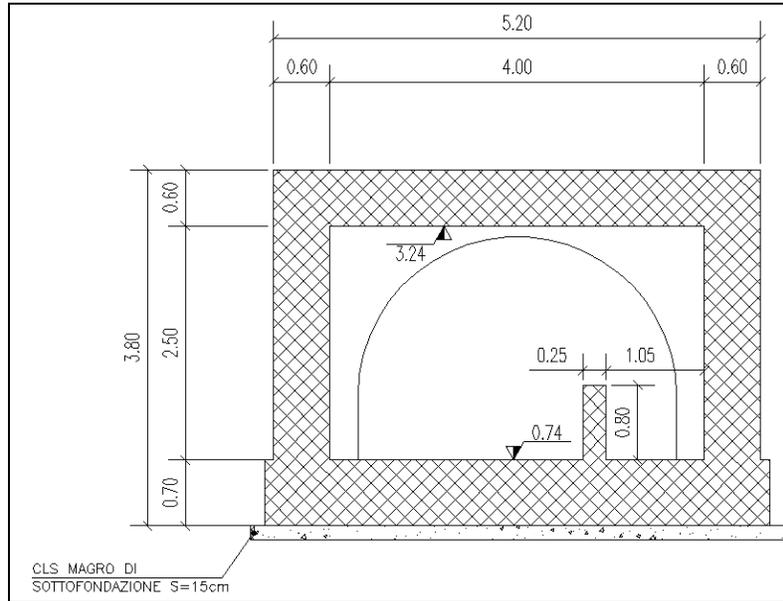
stralcio planimetrico di dettaglio attraversamento idraulico 4.00x2.50
